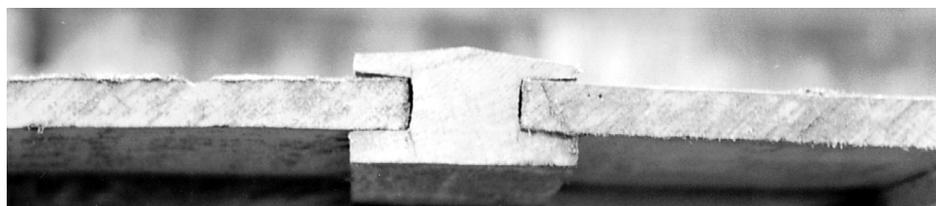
Detalhe do sistema construtivo em madeira serrada
